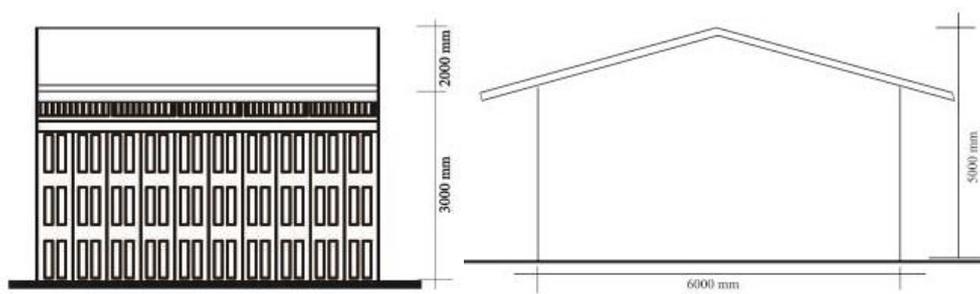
Proporsi bangunan 3 lantai di Pecinan
